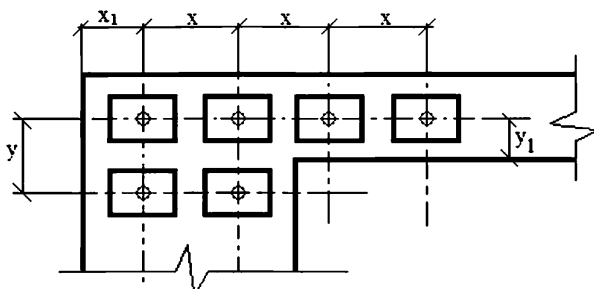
Схема расположения анкеров арматурных элементов по торцам конструкций (требуемые величины x , x_1 , y , y_1 приведены в таблице 6)
